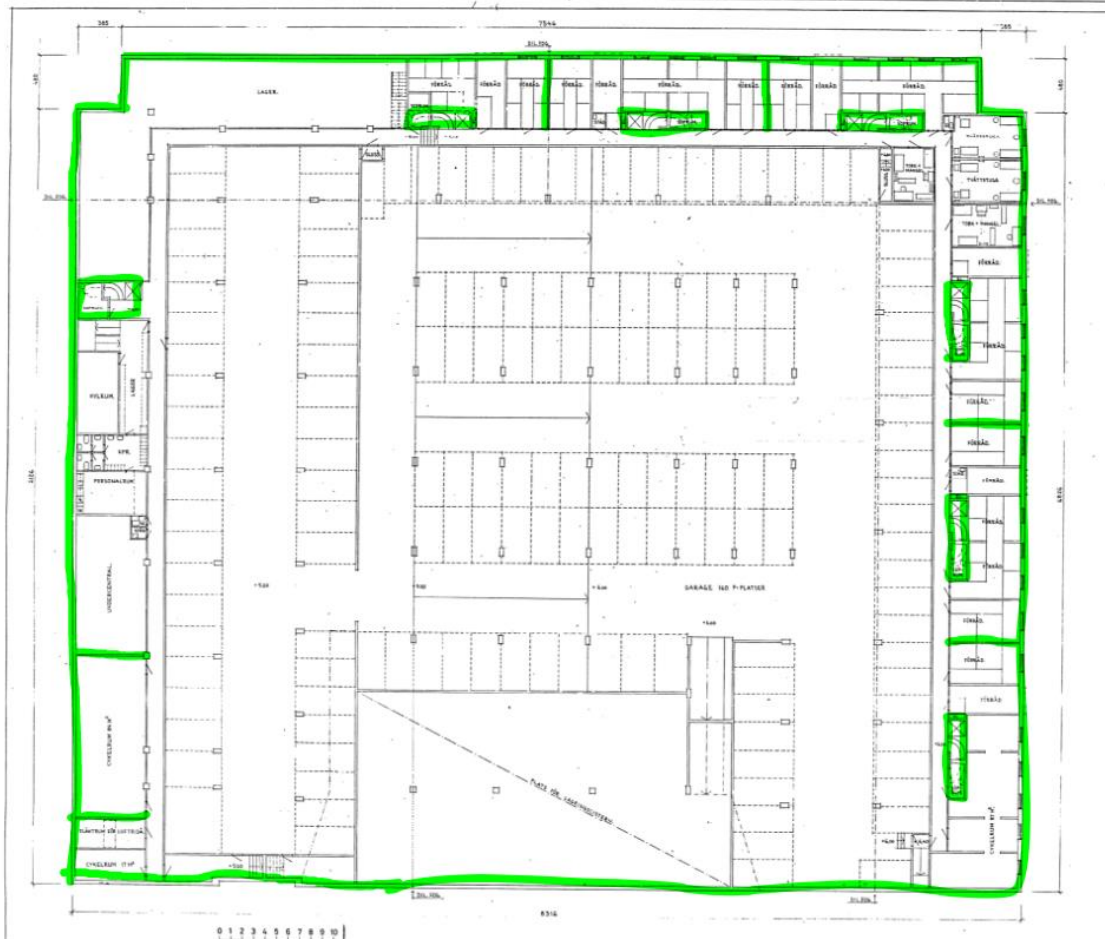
Typplan för i plan 1 och 2 del A, Kv Sigrun.
